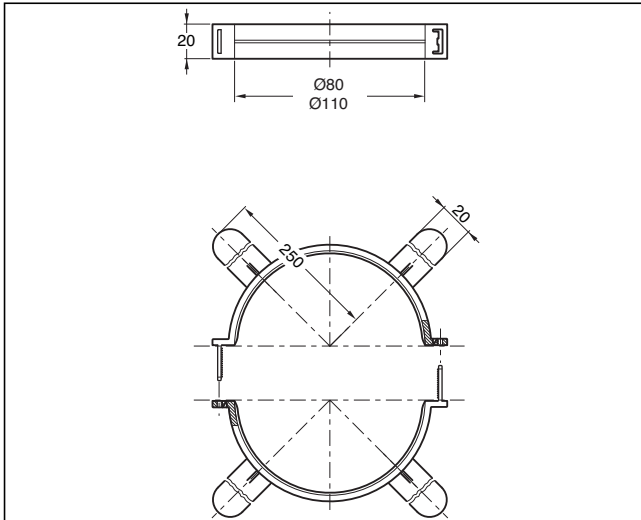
Abstandshalter für Abgasleitung im Schacht (Maße in mm)
